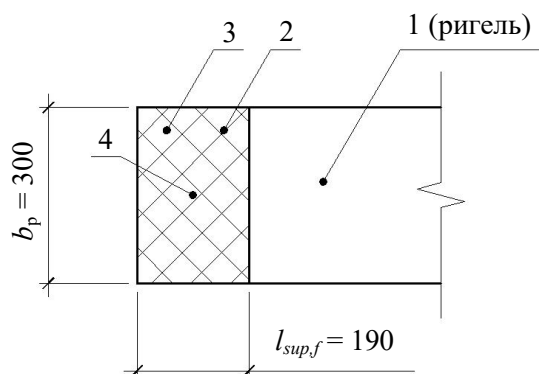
Схема для расчета ригеля на местное сжатие при расположении местной нагрузки у края (торца) элемента по всей его ширине; 1 – элемент, на который действует местная нагрузка (ригель);
